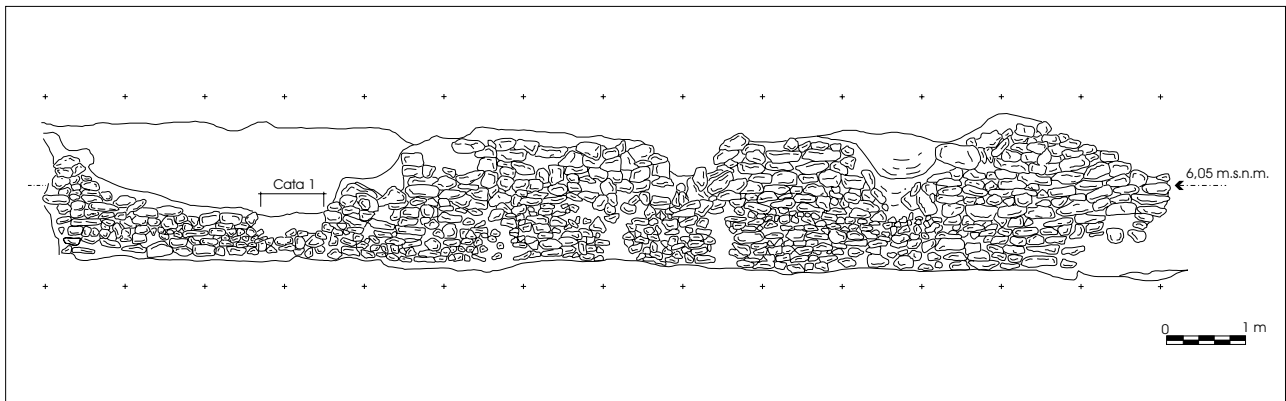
Alzado del recubrimiento de mampostería de la cisterna nº 1. 2001
